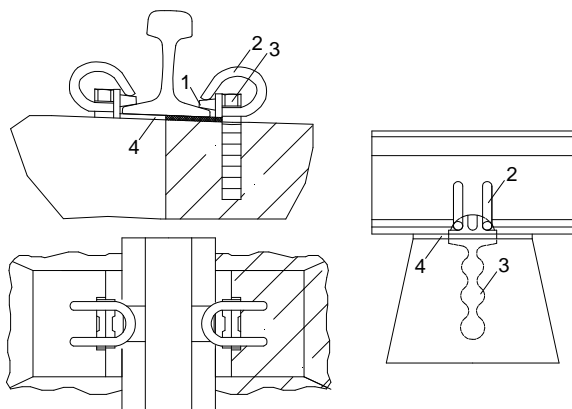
Нераздельное бесподкладочное анкерное крепление СБ-3:
